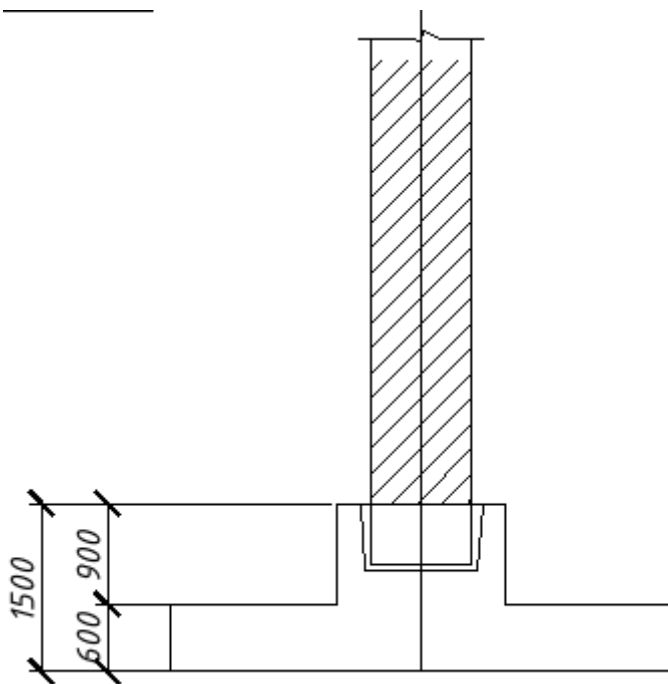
Попереднє конструювання окремого (стовпчастого), монолітного фундаменту без підвалу під збірну залізобетонну колону.
